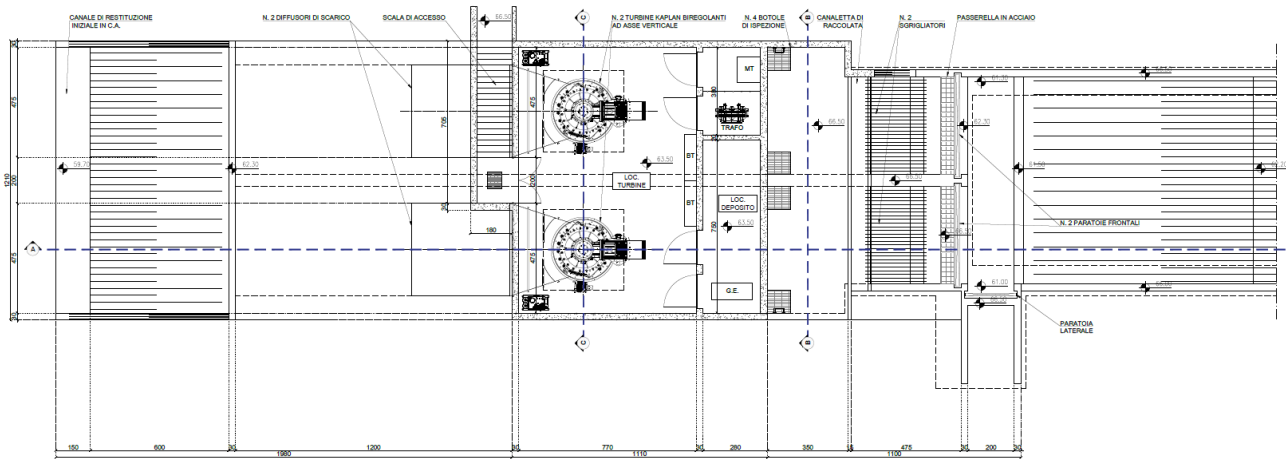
Pianta dell'edificio di centrale in progetto (elaborato ELG204)
